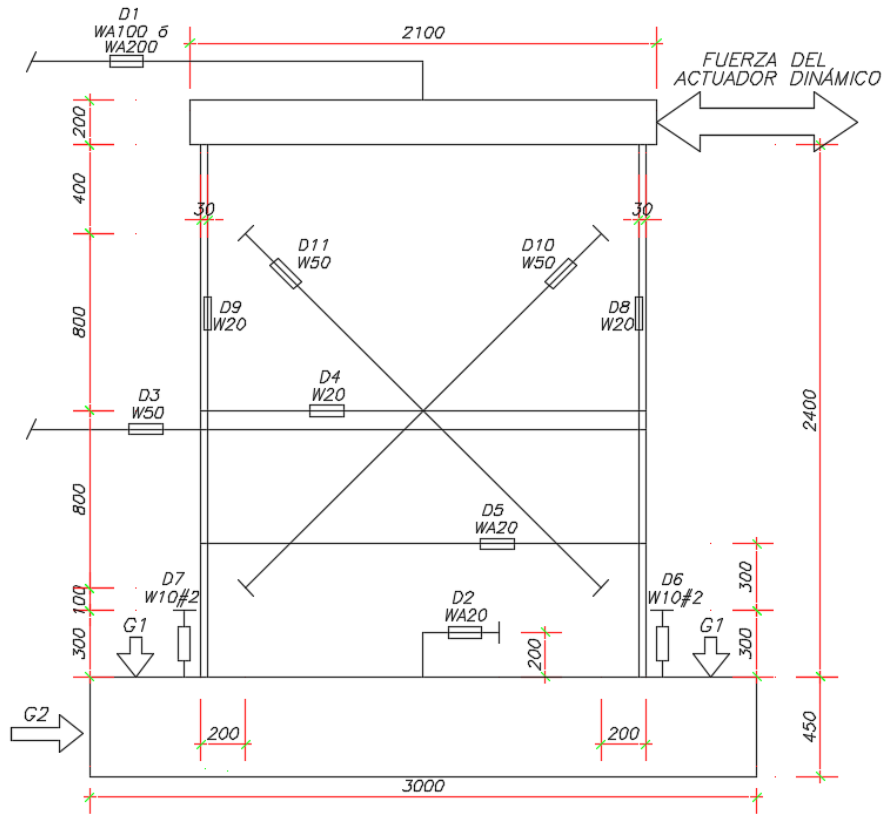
Instrumentación del muro reparado y reforzado para el ensayo.
